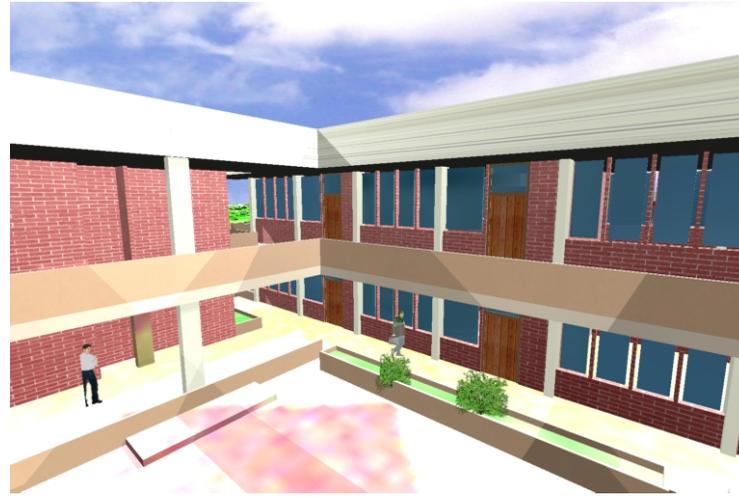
VISTA DE LA PLAZA INTERNA DE LOS EDIFICIOS
